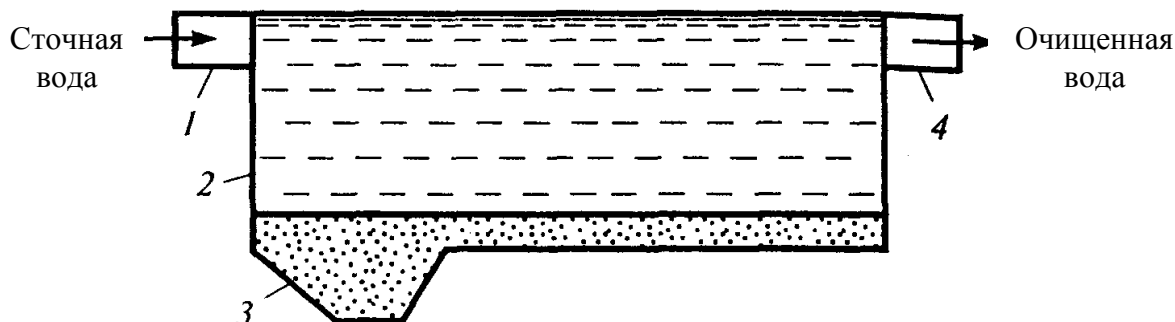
Схема горизонтальной песколовки с прямолинейным движением воды: 1 – входной патрубок; 2 – корпус песколовки; 3 – шламосборник (песковой приемок), 4 – выходной патрубок
